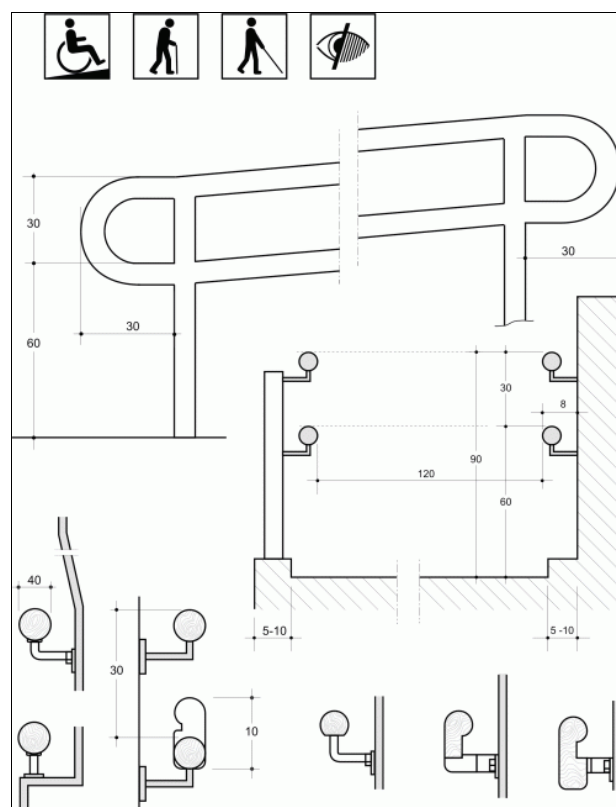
Dimenzije i rješenja izvedbe rampe po Pravilniku
